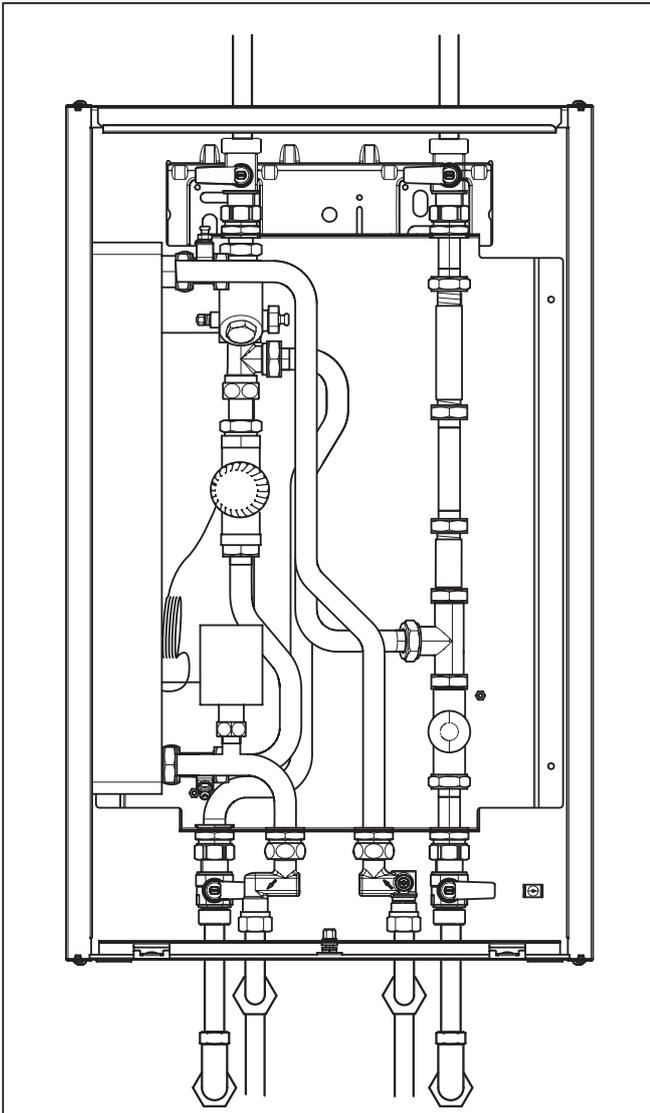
Wasser- und heizungsseitiger Anschluss
